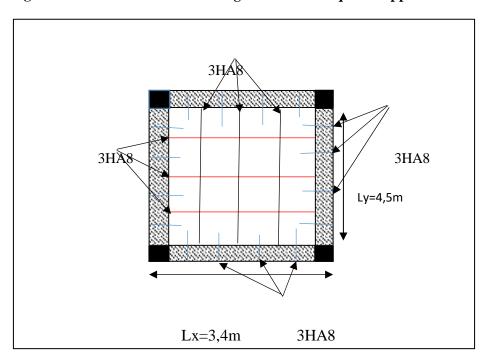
Schéma de ferraillage de dalle sur quatre appuis D4
